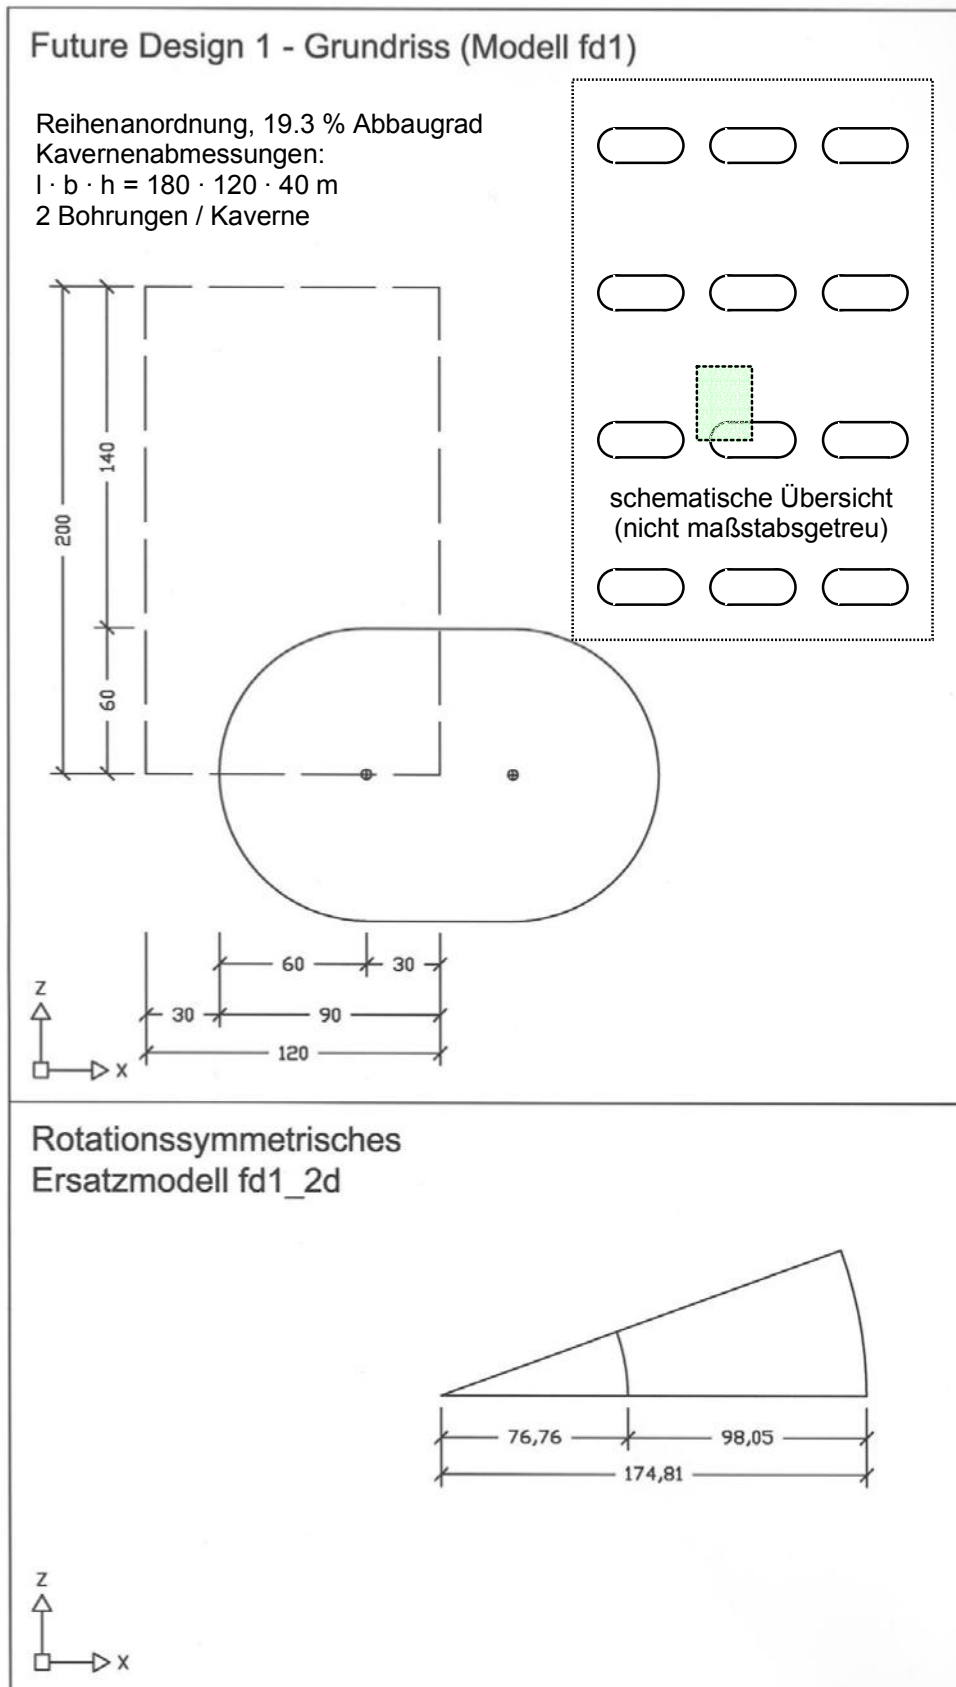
Future Design 1 – Grundriss und rotationssymmetrisches Ersatzmodell
